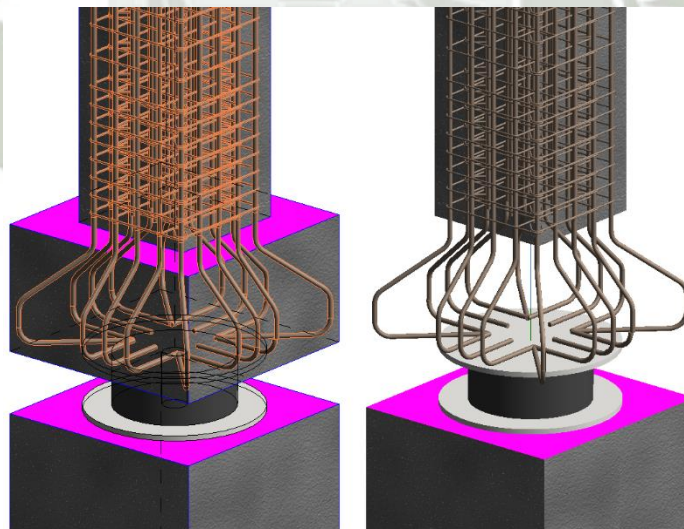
A: Vista tridimensional entre la conexión del cubo rectangular de concreto armado y el aislador.
